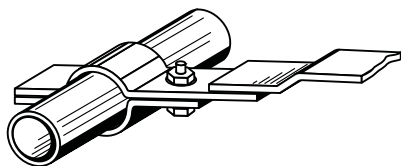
Присоединение к трубопроводу заземляющего проводника при помощи хомута
